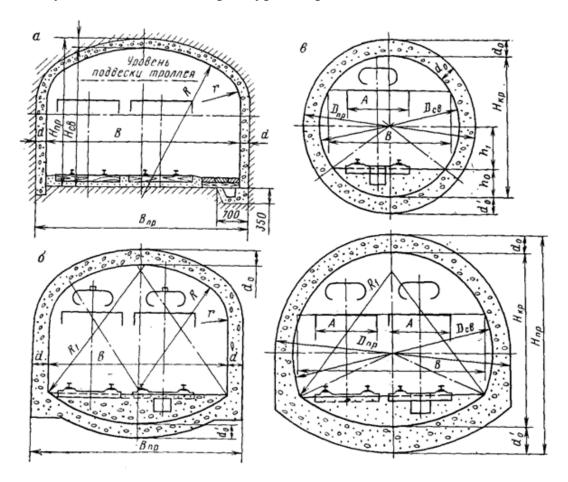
Монолитные бетонные крепи Условные обозначения: а — с вертикальными стенками и сводчатым перекрытием; б — с вертикальными стенками и обратным сводом; в — цилиндрическая и арочная с обратным сводом крепи для сложных горногеологических условий
